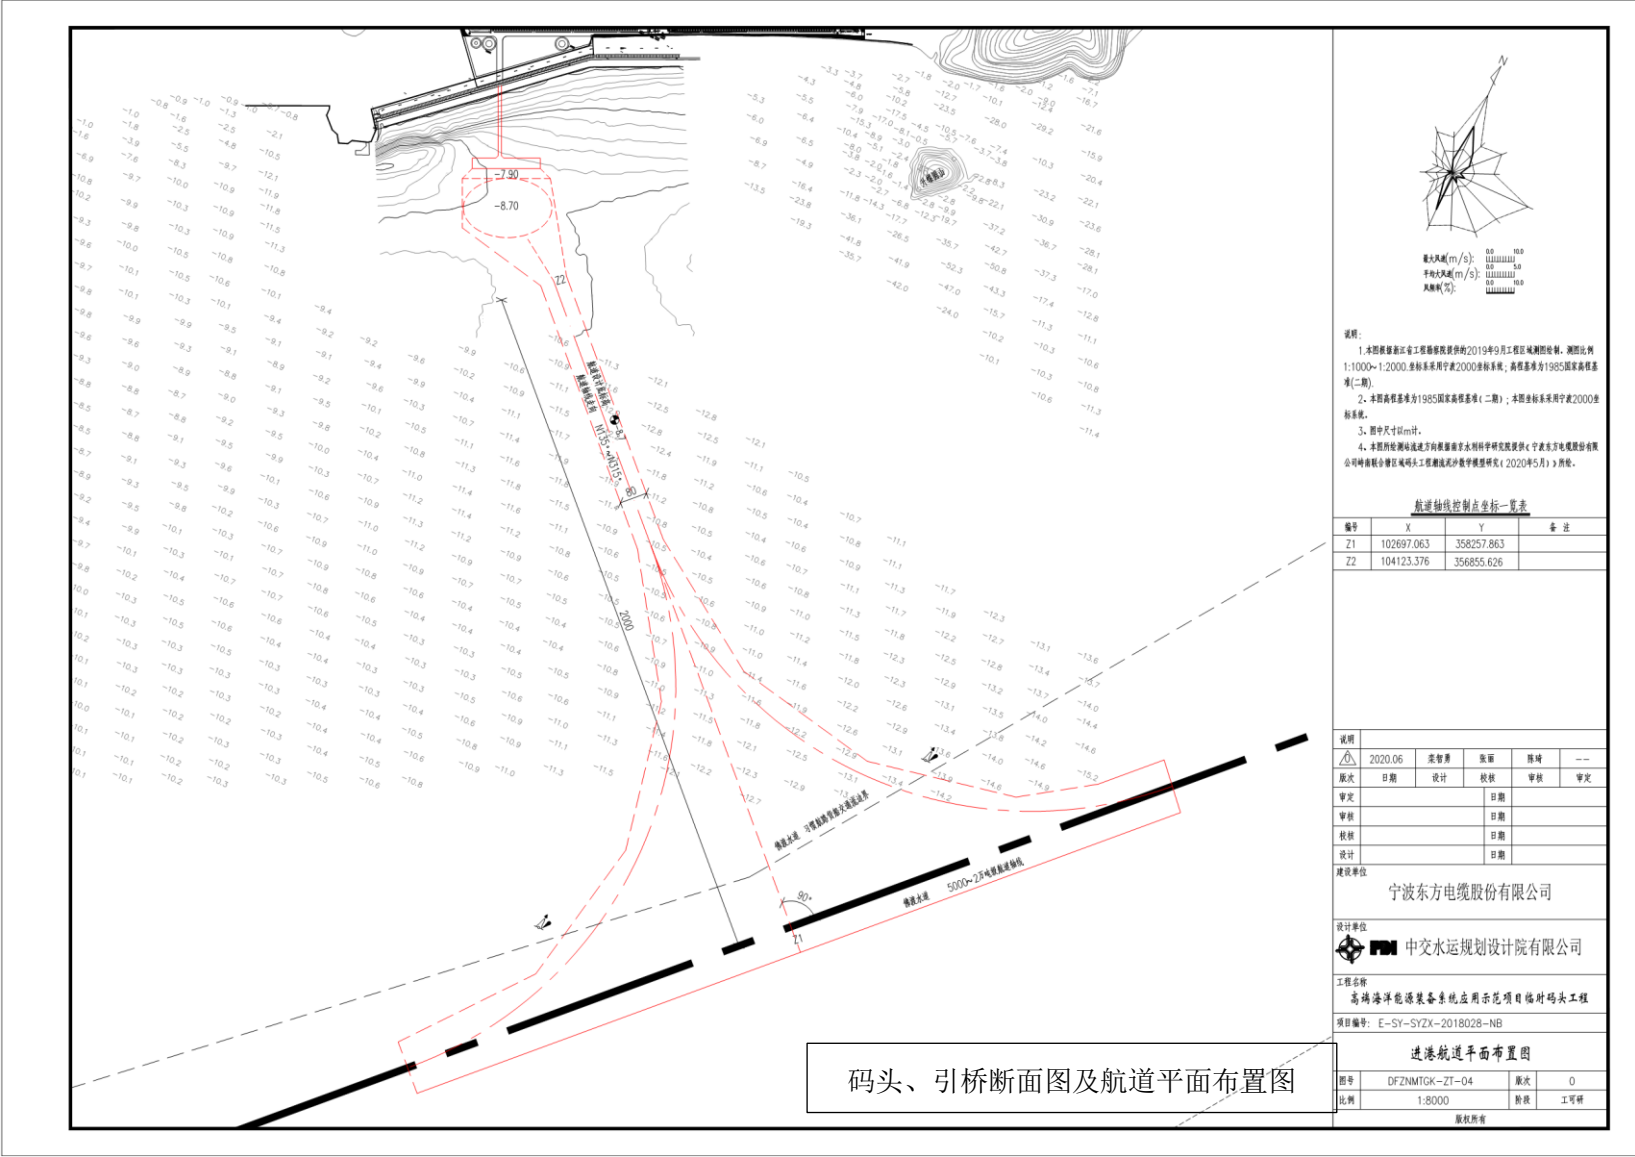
现有码头、引桥断面图及航道平面布置图
